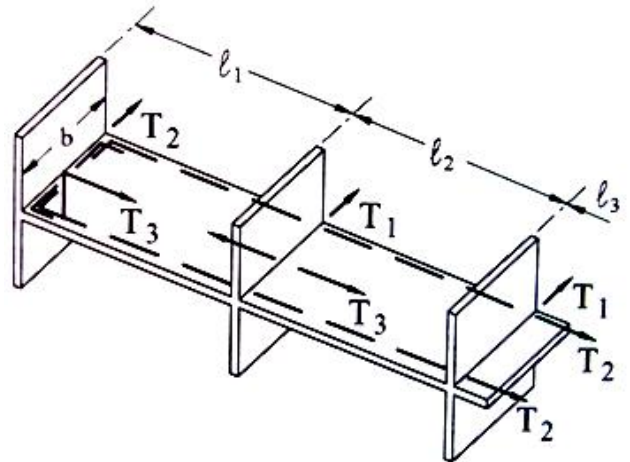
Горизонтальные усилия в перекрытии крупнопанельного здания
